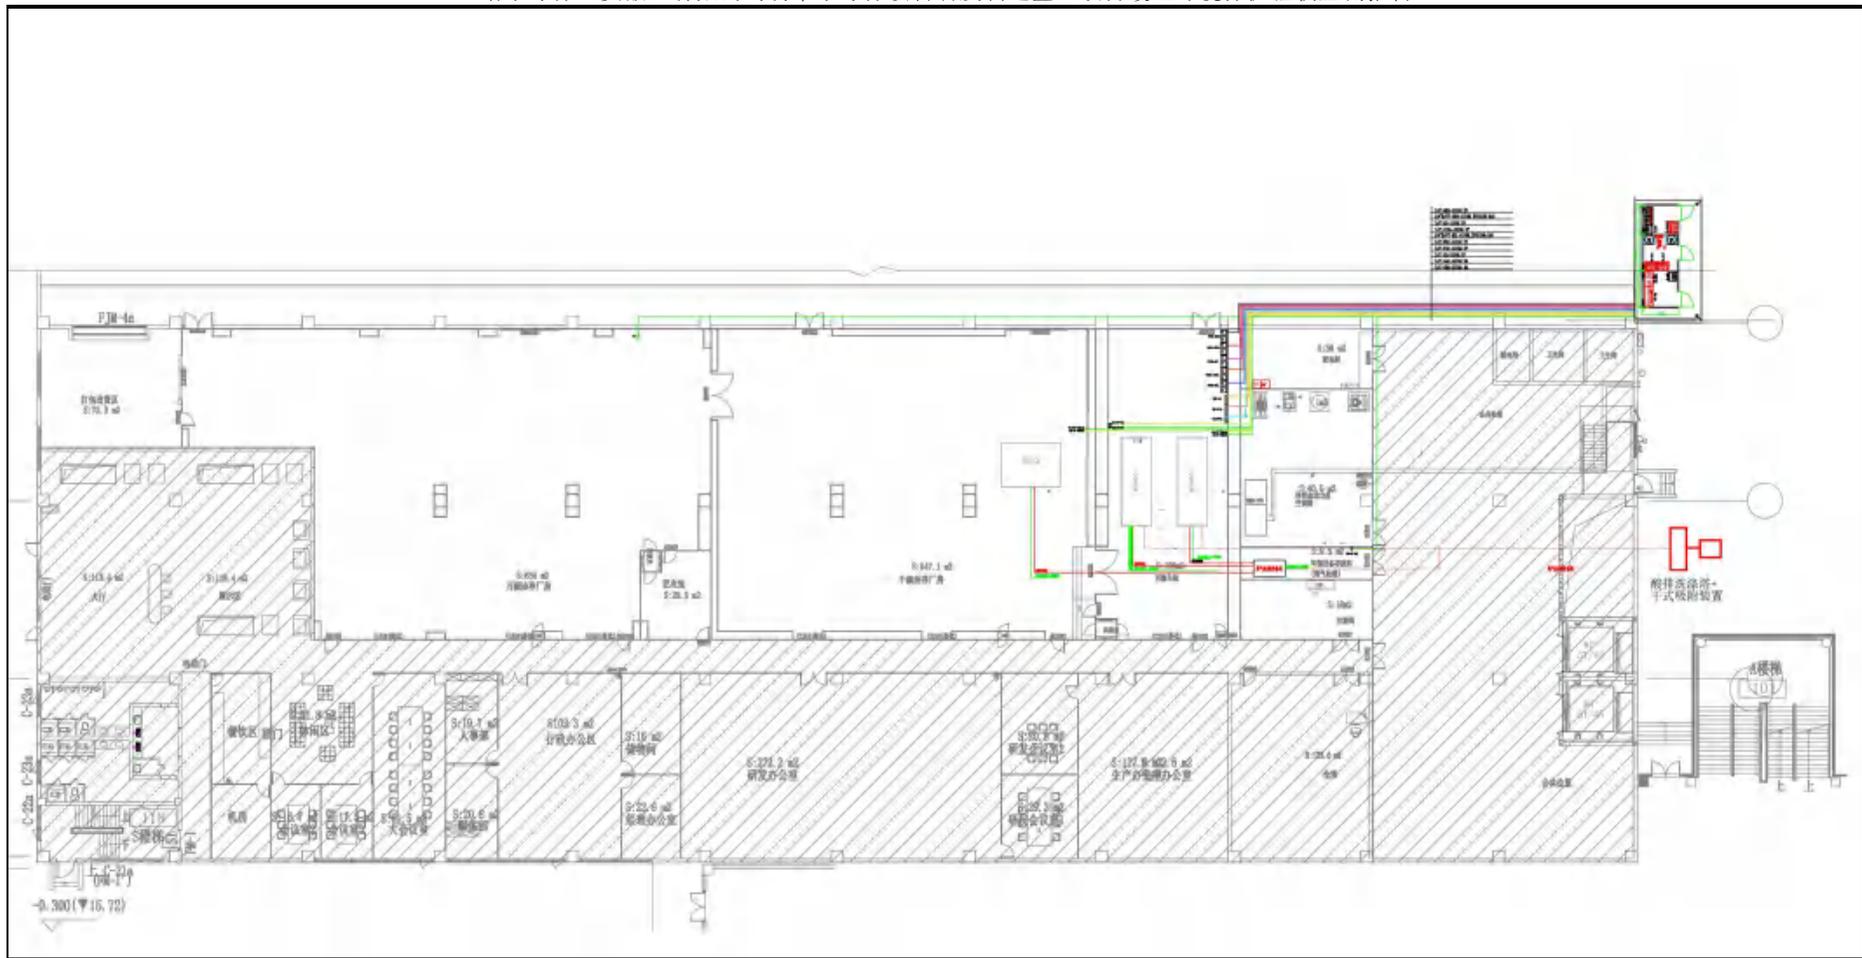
一塔半导体（安徽）有限公司厂区总平面布置图
